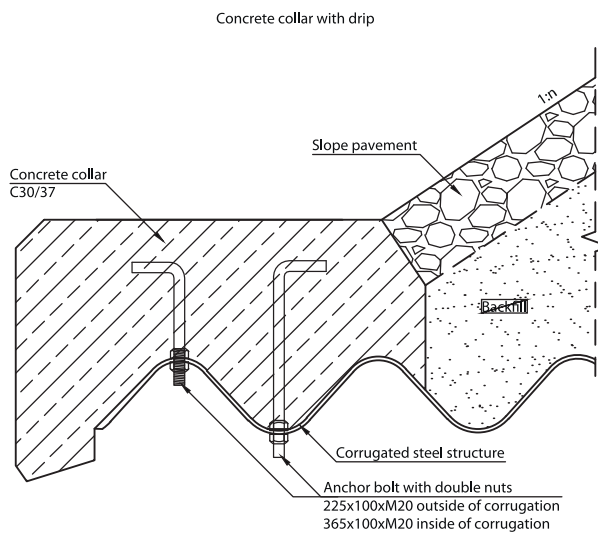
Exemple de guler din beton realizate la capetele structurii
